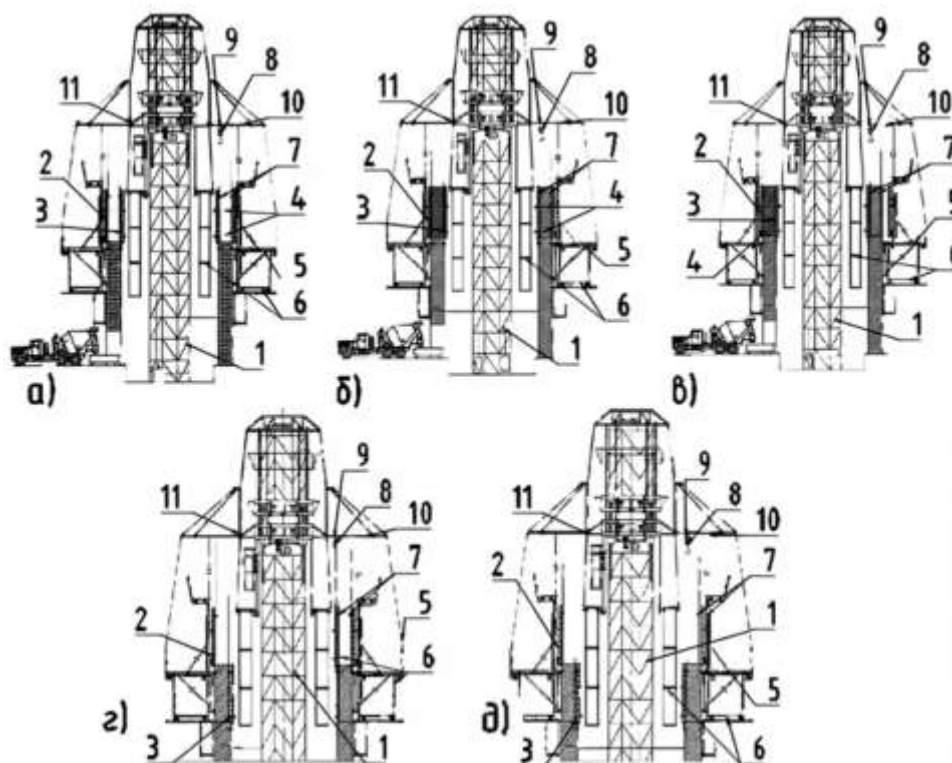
Подъемно-переставное устройство для возведения стен и перекрытий (авторское свидетельство № 1629437 А1): (а) бетонирование плиты перекрытия и половины высоты стены; (б) установка блочной опалубки на вторую половину высота этажа; (в) перевод блочной опалубки на следующий этаж; (г) перевод опалубки для бетонирования плиты перекрытия на следующий этаж
